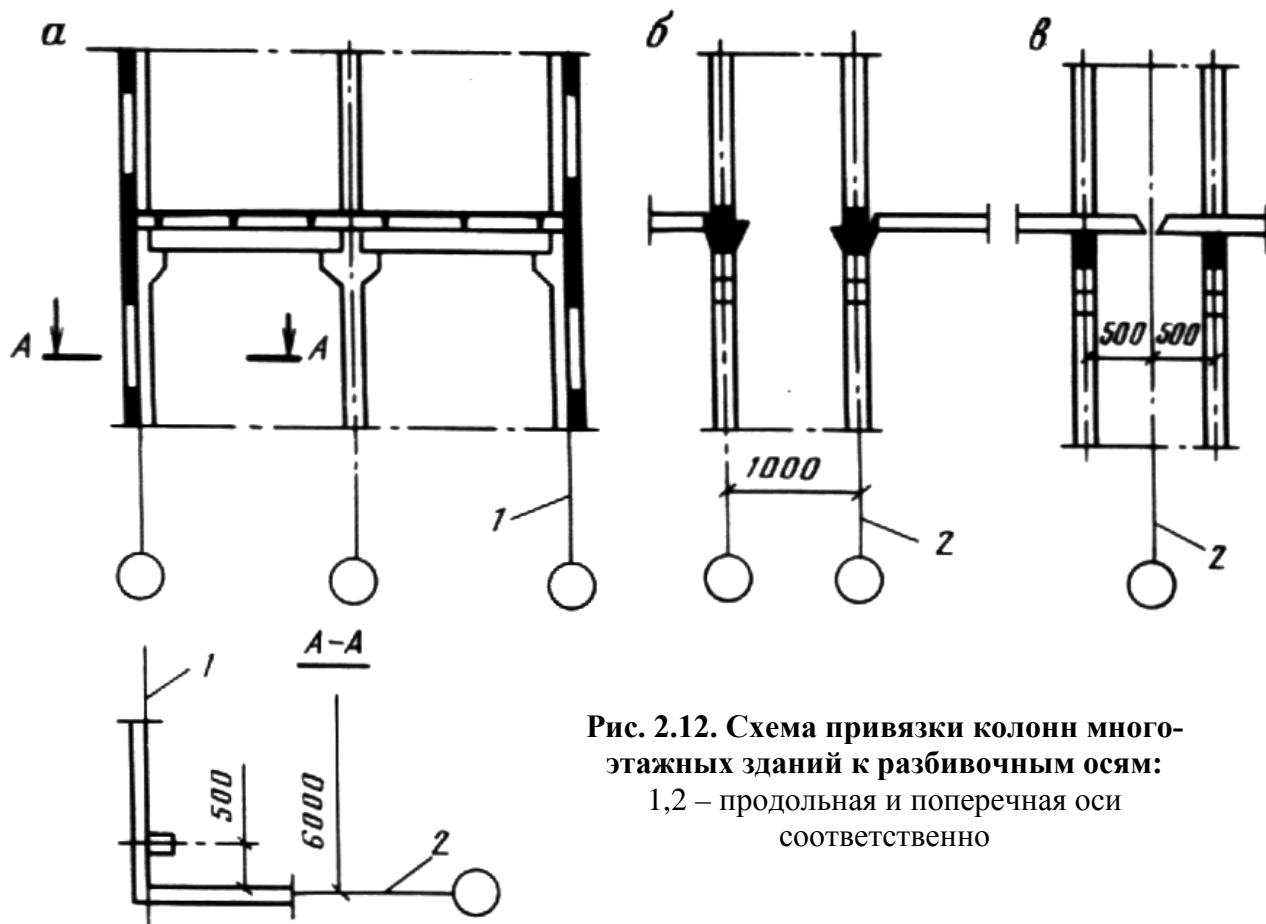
Схема привязки колонн многоэтажных зданий к разбивочным осям:
